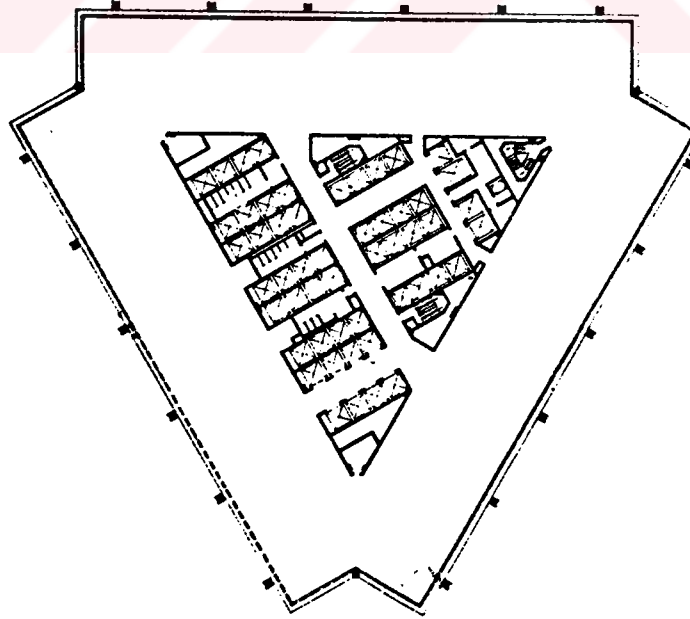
Plan Tiplerine Göre Çekirdek Yerleşim Örnekleri
